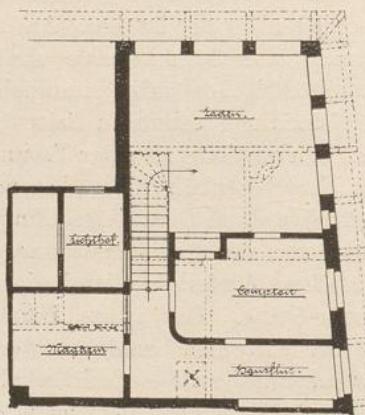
Steinheimer; Grundriss des Erdgeschosses.
